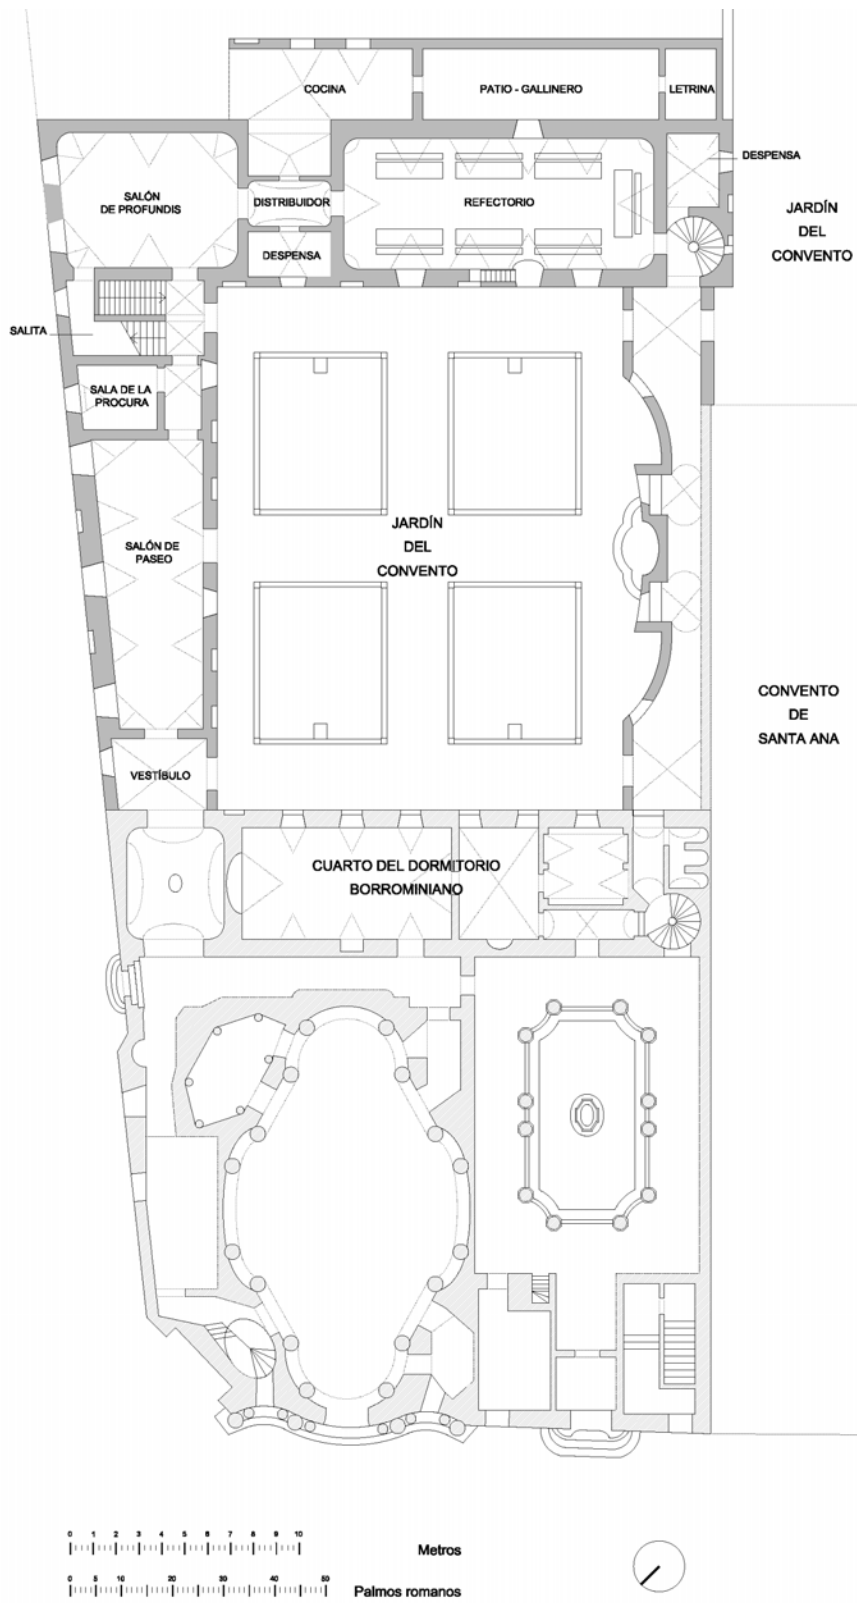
Disegno dell'autrice. Pianta piano terra.
